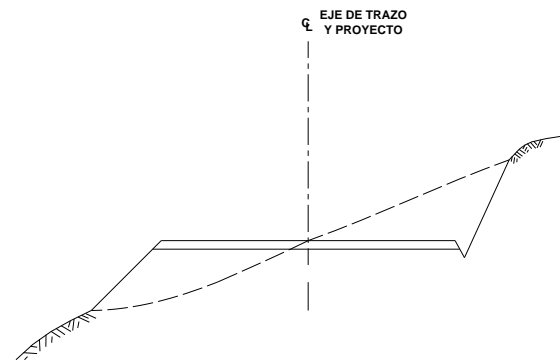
Secciones en Terraplén, Corte y Balcón
